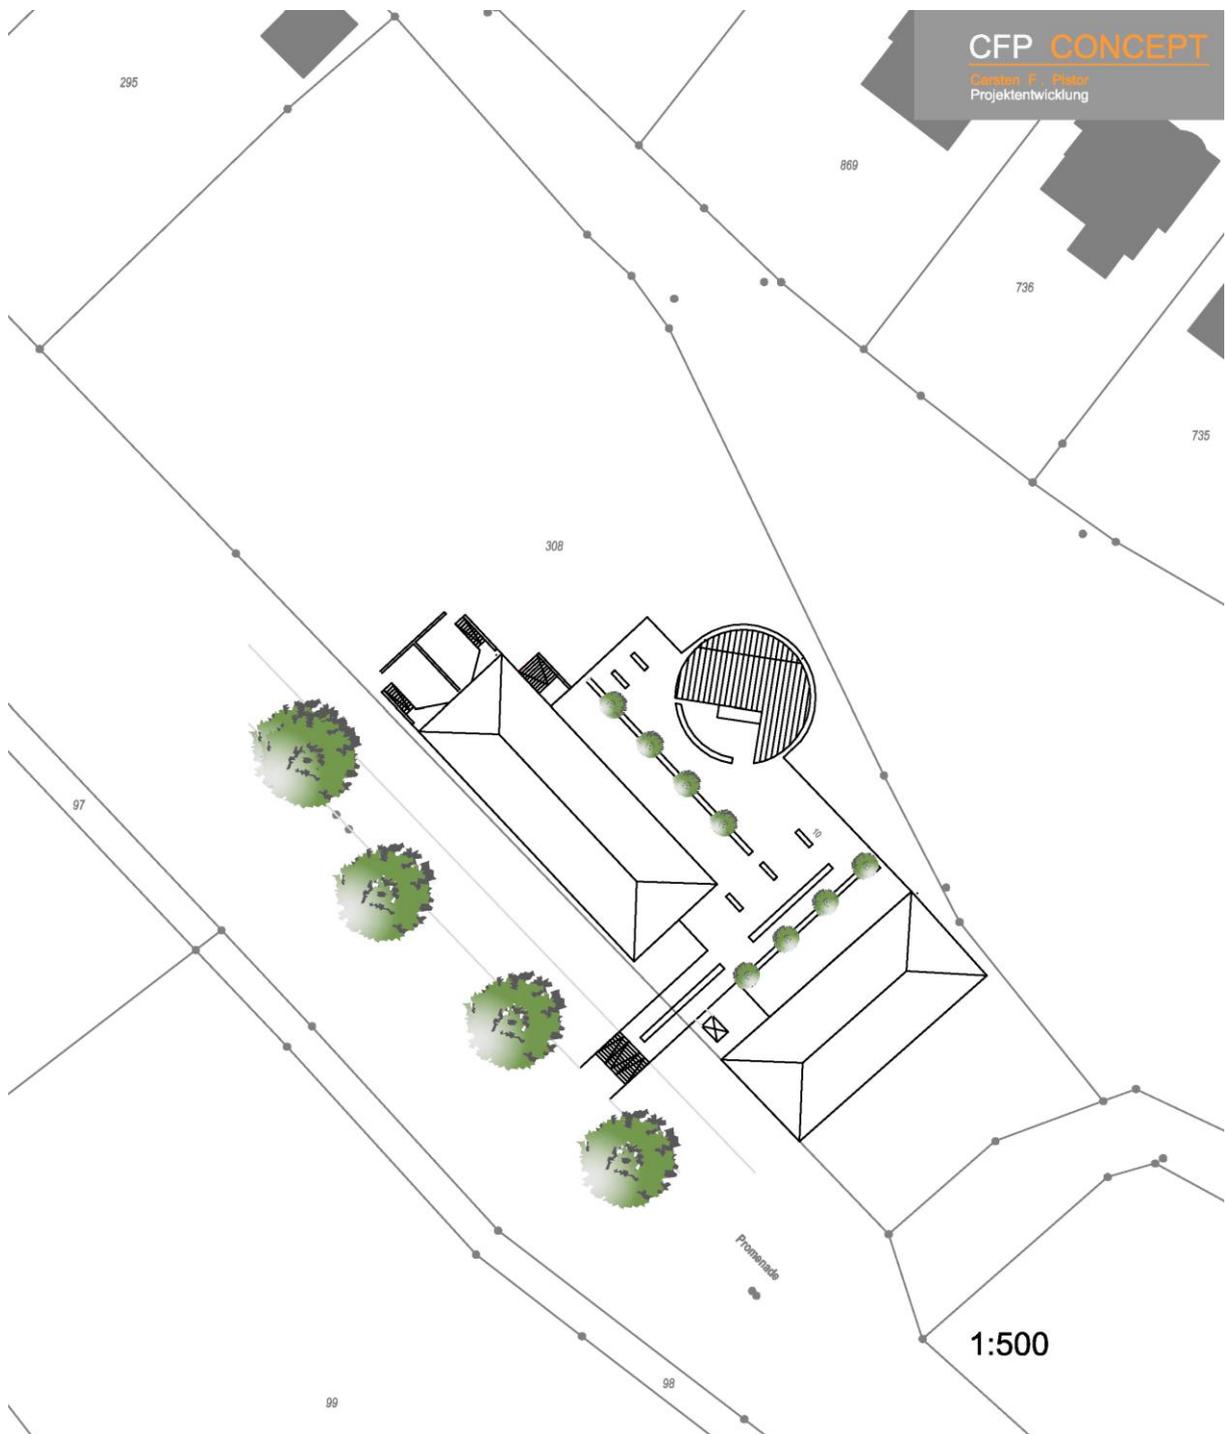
Projektplanung Lageplan (Alain Rosa Architekt, September 2015)
